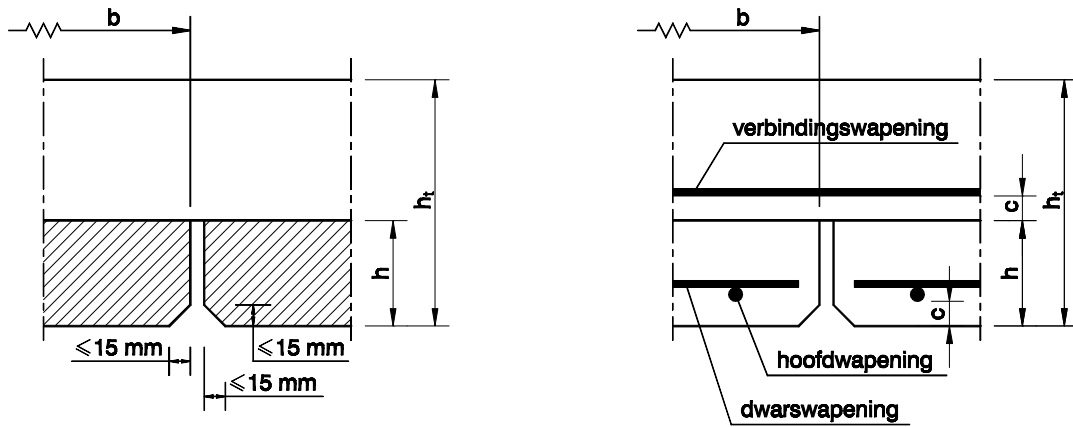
d - Breedplaten zonder afgeschuinde langsrand¹ bovenaan:
